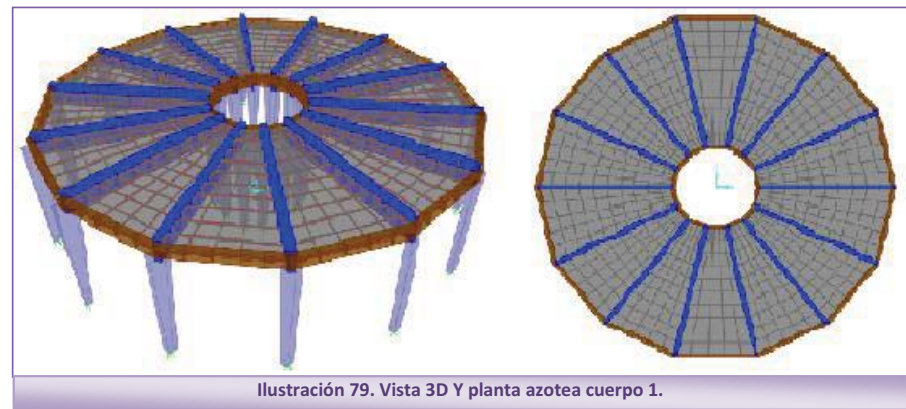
Vista 3D Y planta azotea cuerpo 1.
